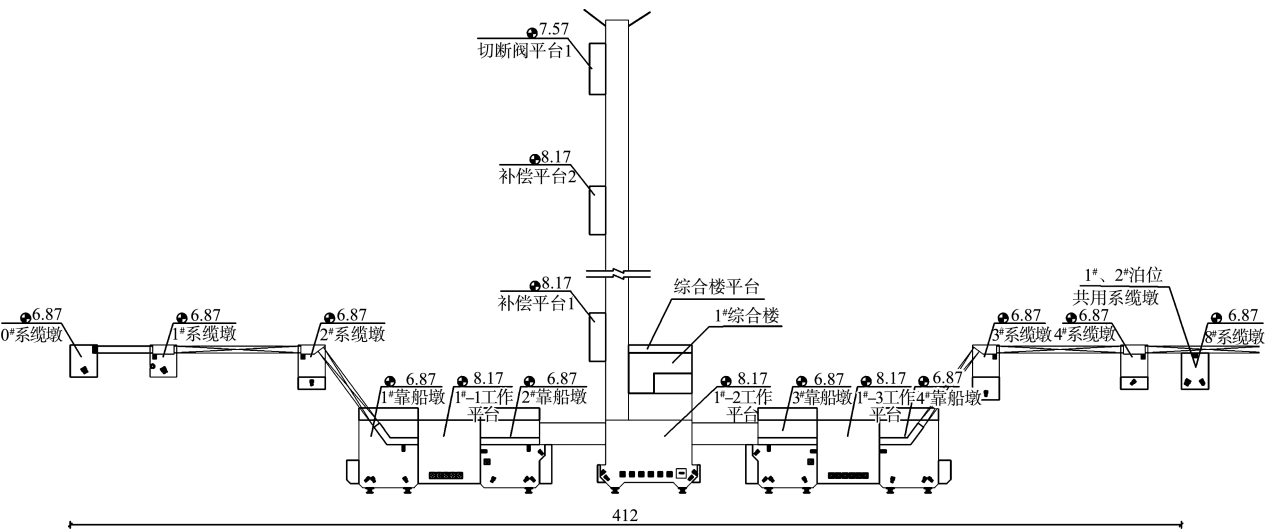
改扩建后 1[#]泊位平面布置 (单位: m)
